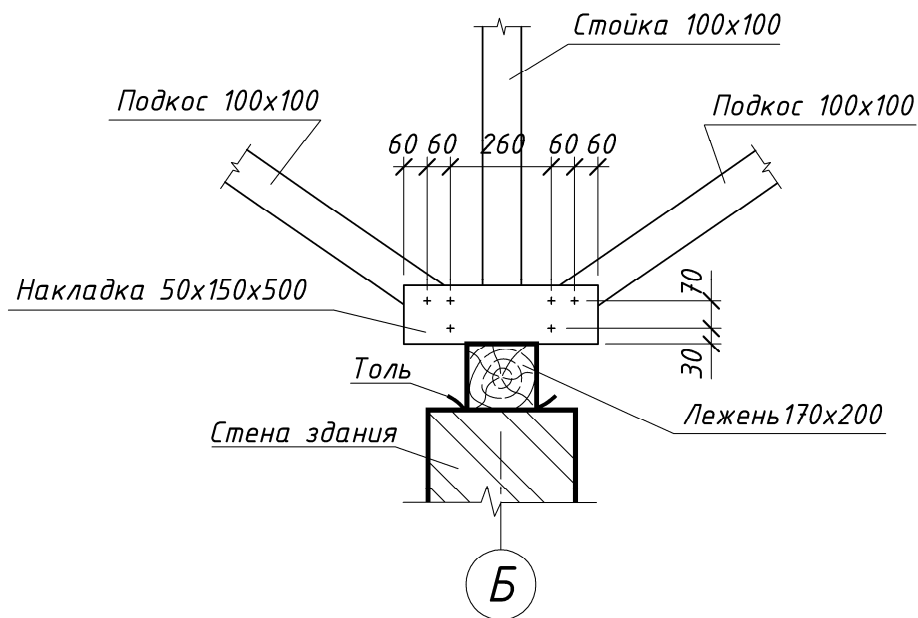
Опорный узел стропильной крыши жилого дома
